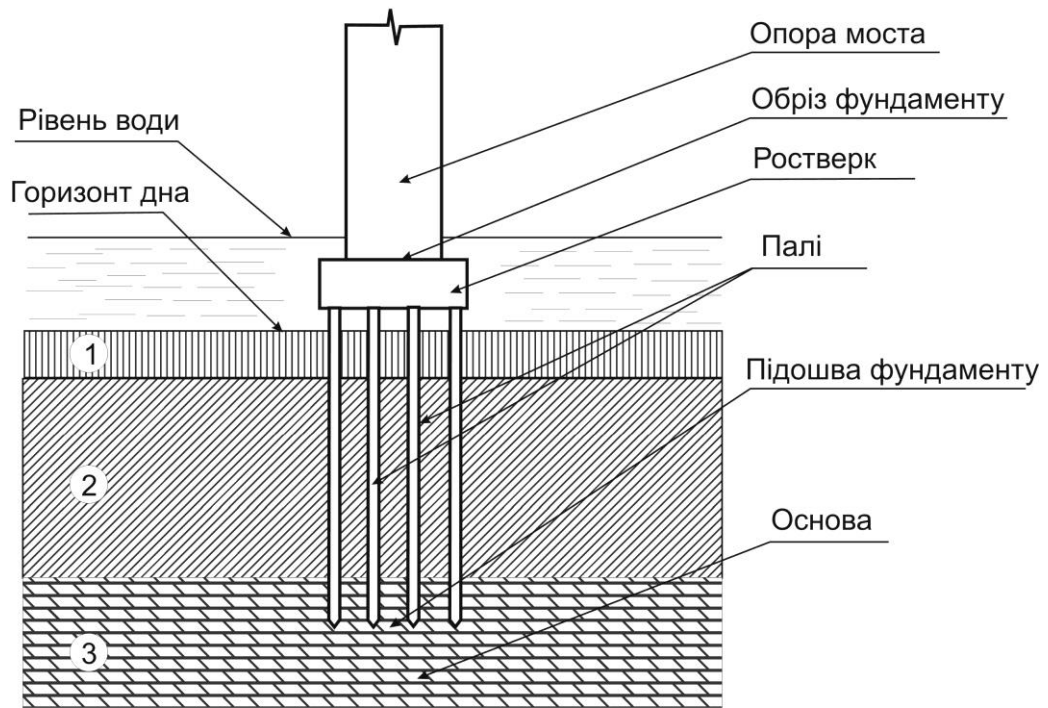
Пальовий фундамент з високим ростверком на водотоці
